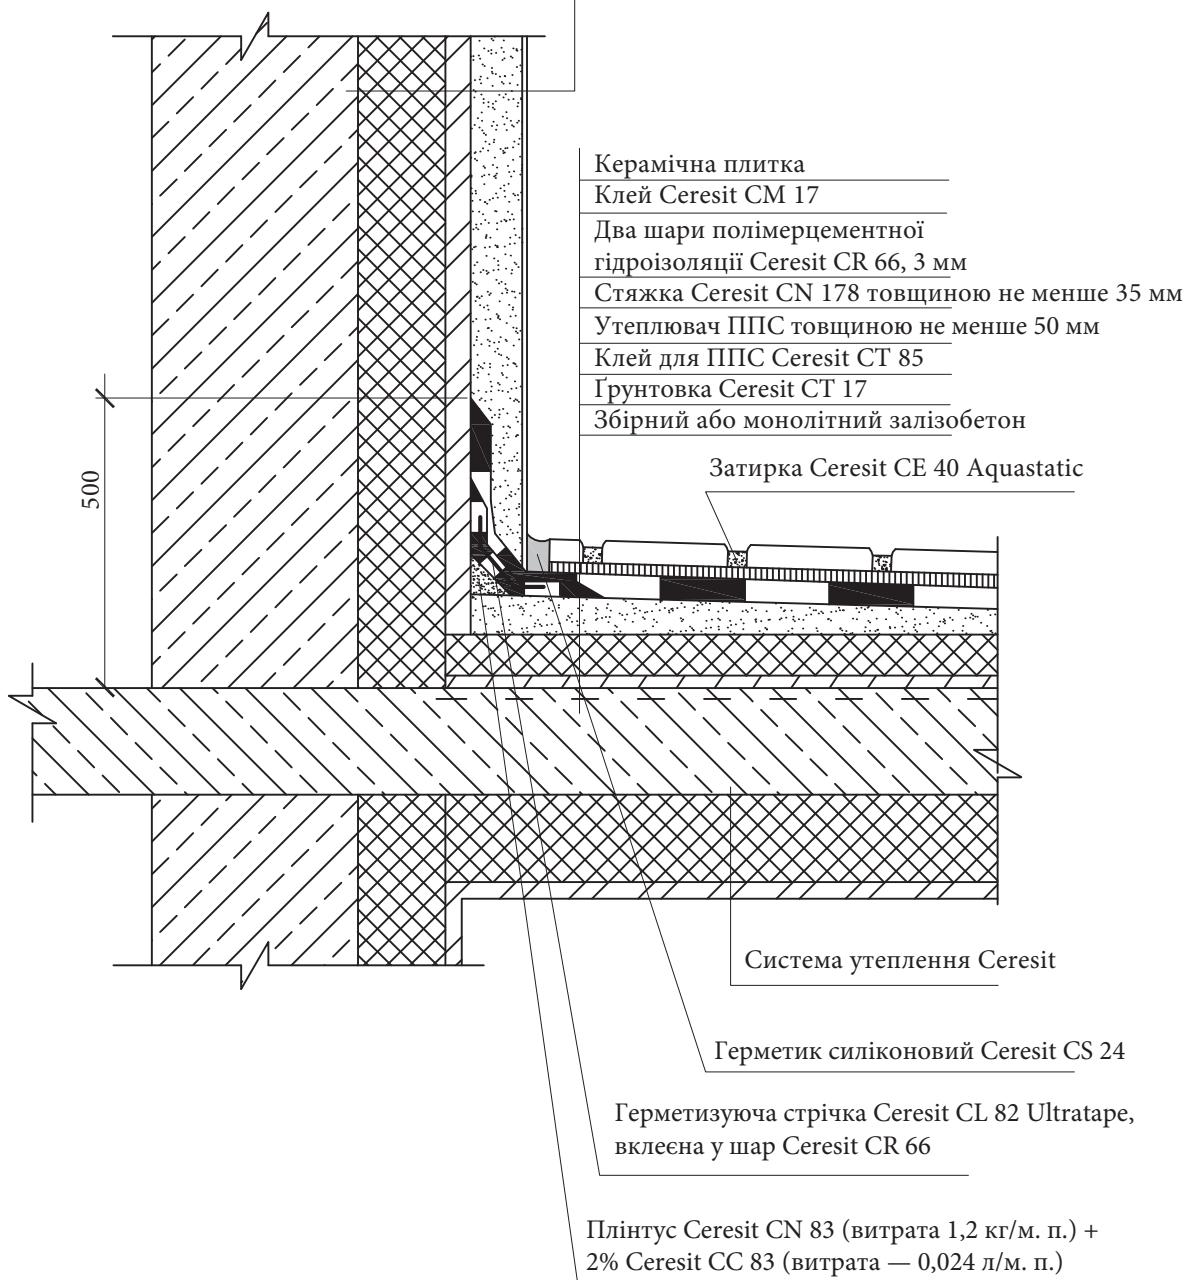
Конструкція гідроізоляції балконів з зовнішнім утепленням
